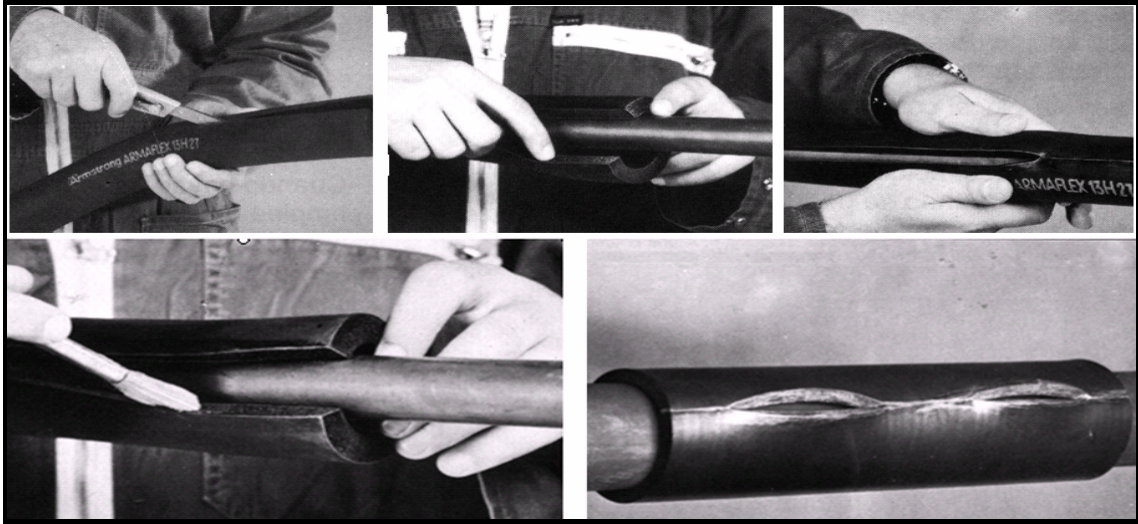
Instalación de aislante cuando la tubería se encuentra instalada
